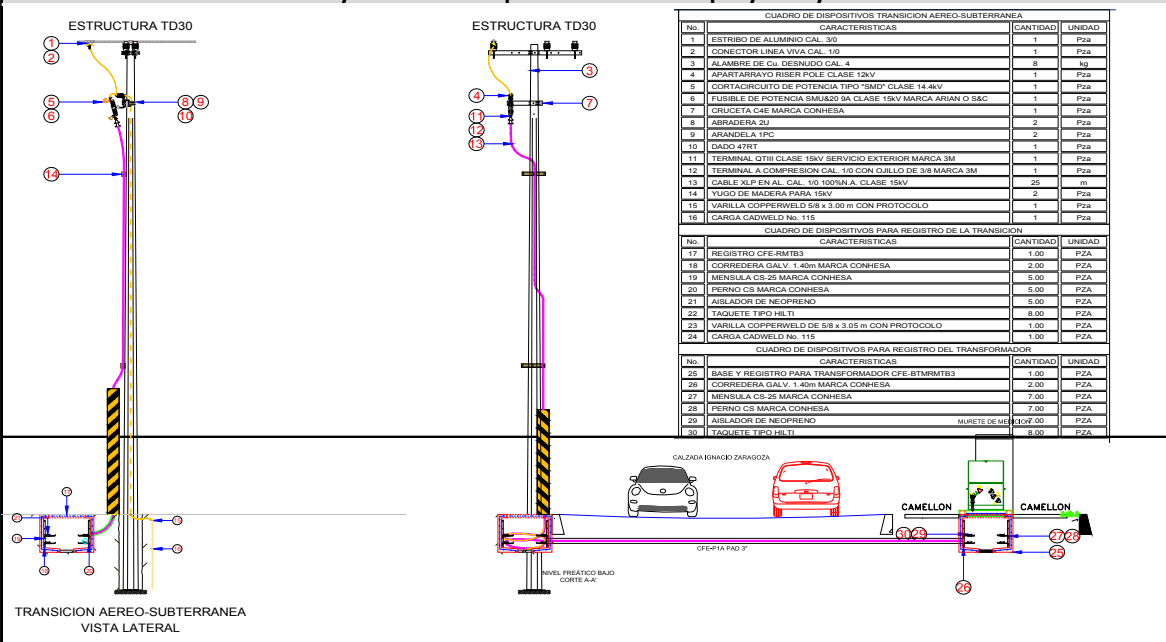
Lista de verificación de obra eléctrica con referencia.
